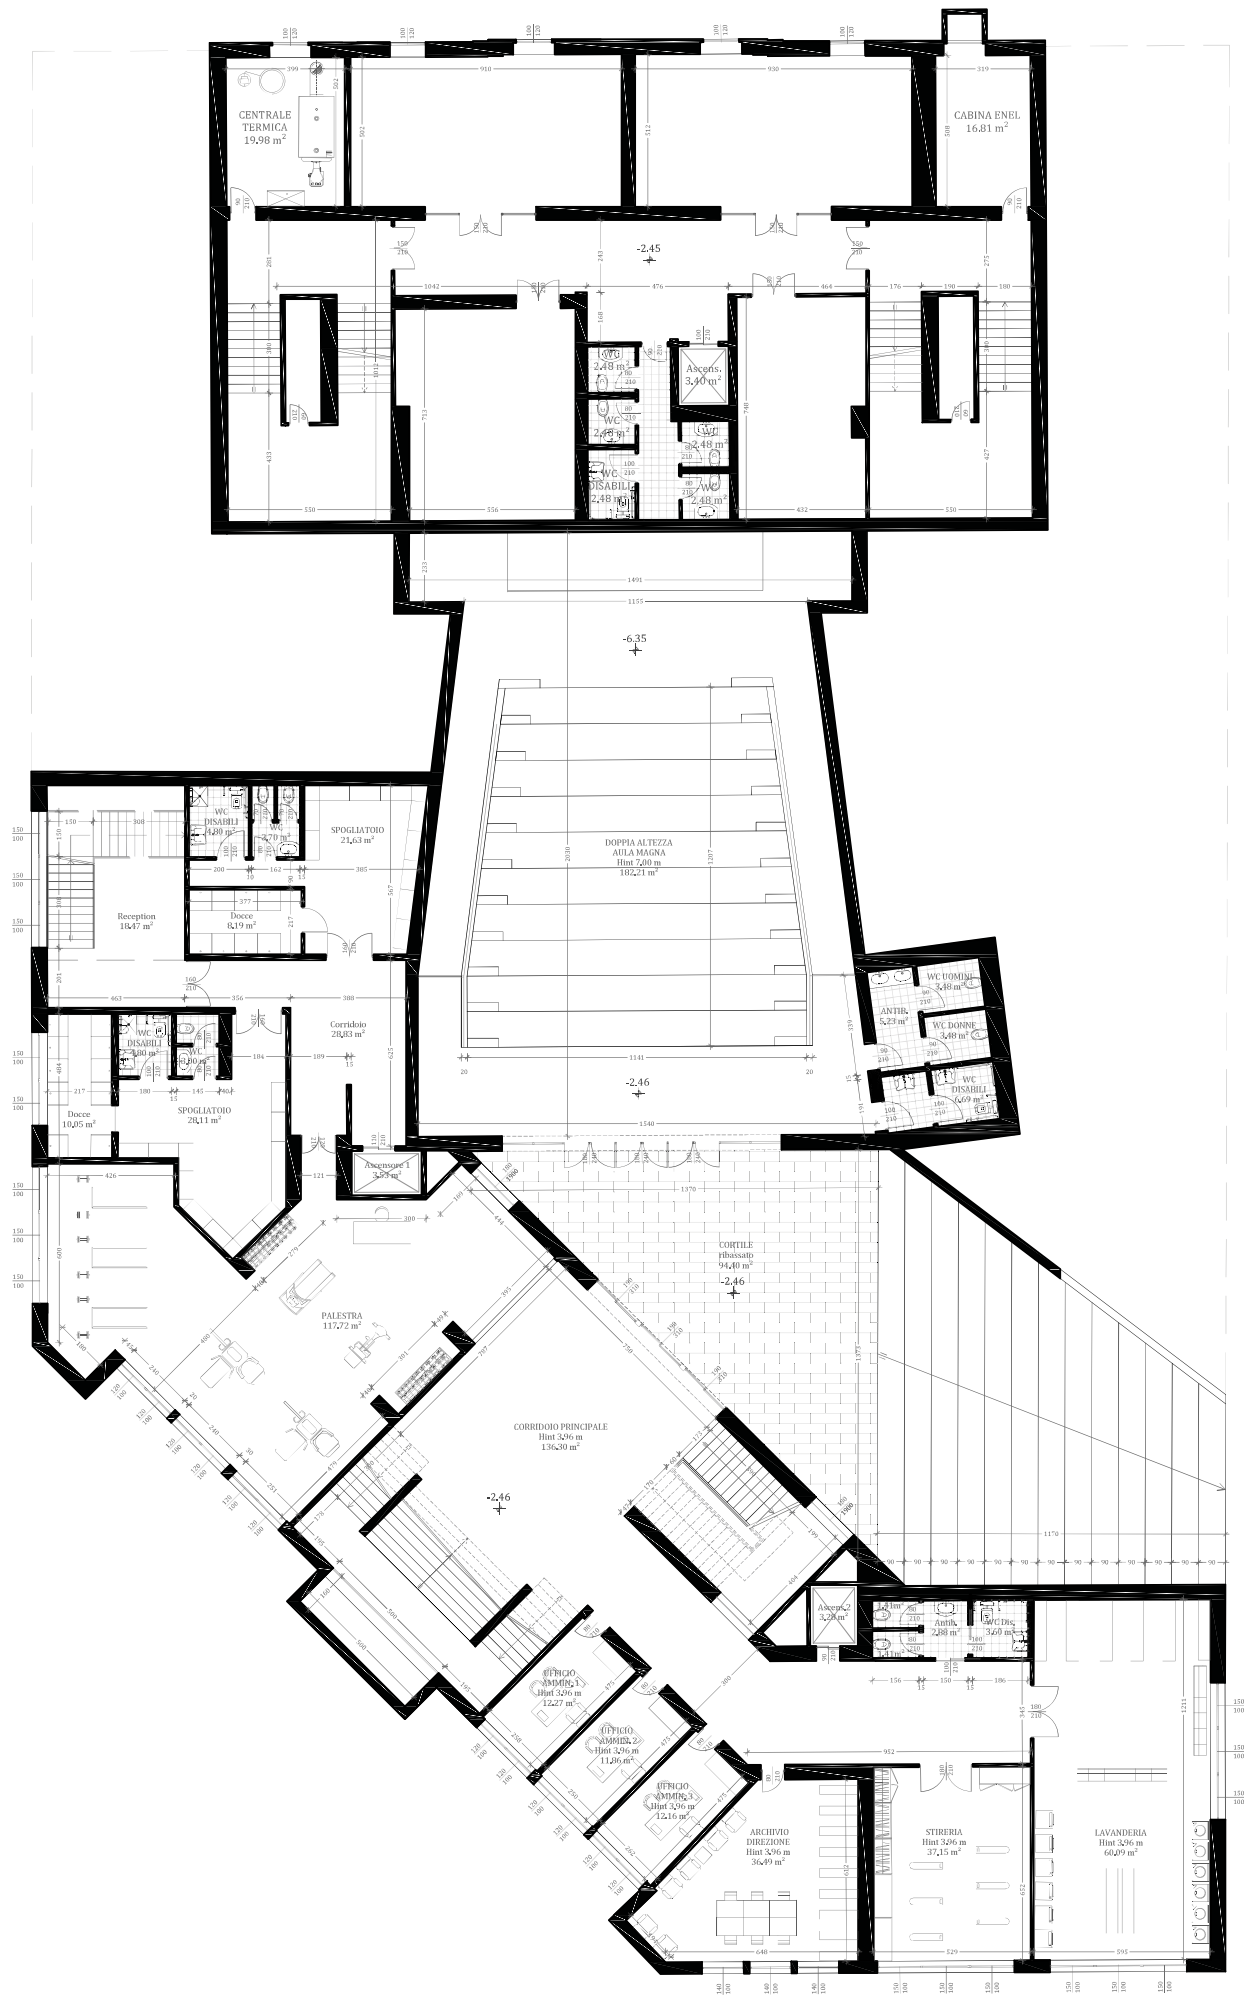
Schema demolizione costruzione, confronto Planimetria Piano Interrato tra SdF e Progetto
